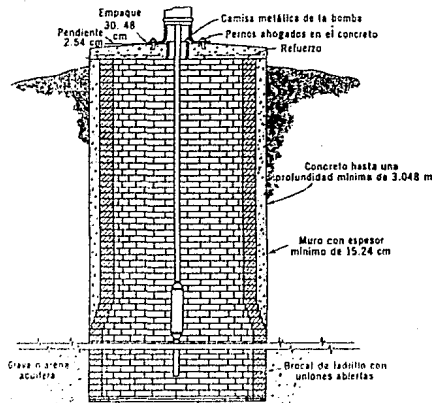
POZO CAVADO CON REVESTIMIENTO DE MAMPOSTERÍA
